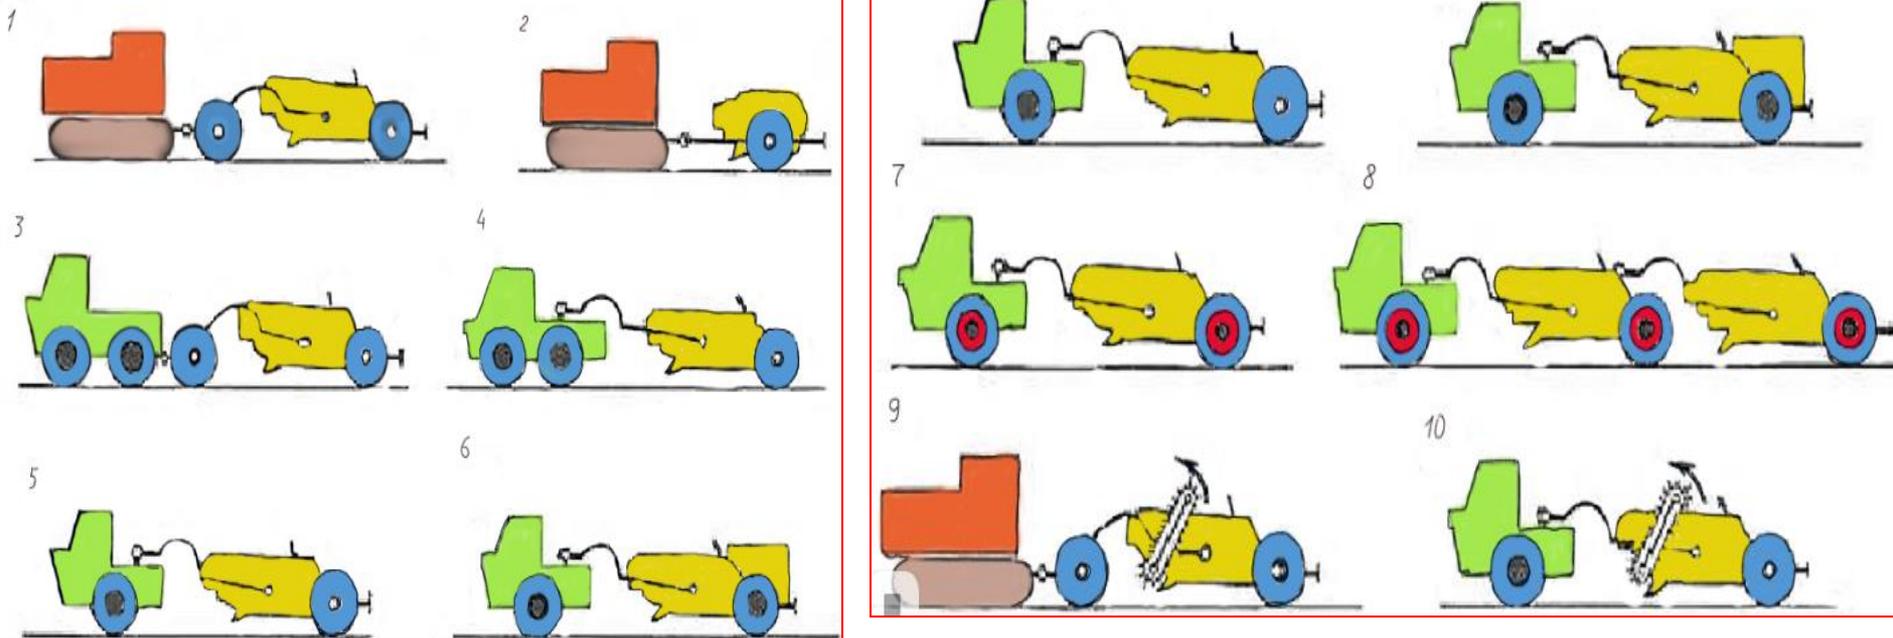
Скреперы: виды компоновки: 1 — прицепной двухосный; 2 — прицепной одноосный; 3 — прицепной двухосный с колесным тягачом; 4 — полуприцепной; 5 — самоходный на базе одноосного тягача с механической передачей; 6 — двухмоторный с механической передачей; 7 — самоходный дизель-электрический; 8 — самоходный двухковшовый дизель-электрический; 9 — прицепной с элеваторной загрузкой; 10 — самоходный с элеваторной загрузкой.
